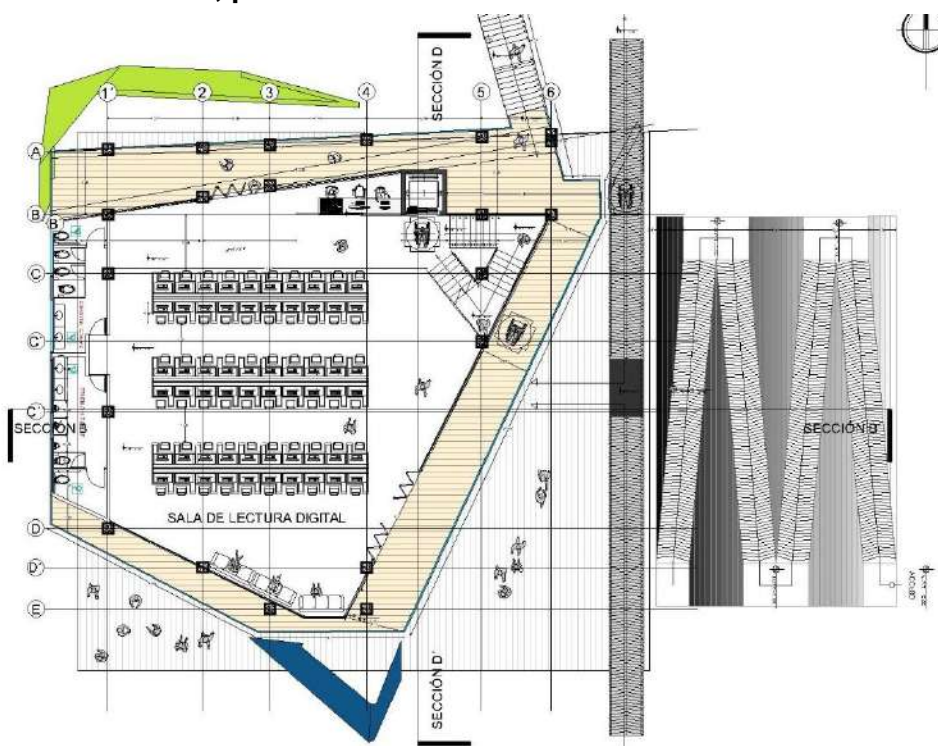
Planimetría edificio lúdico nivel +3.00. Fuente: Elaboración propia 2021.
